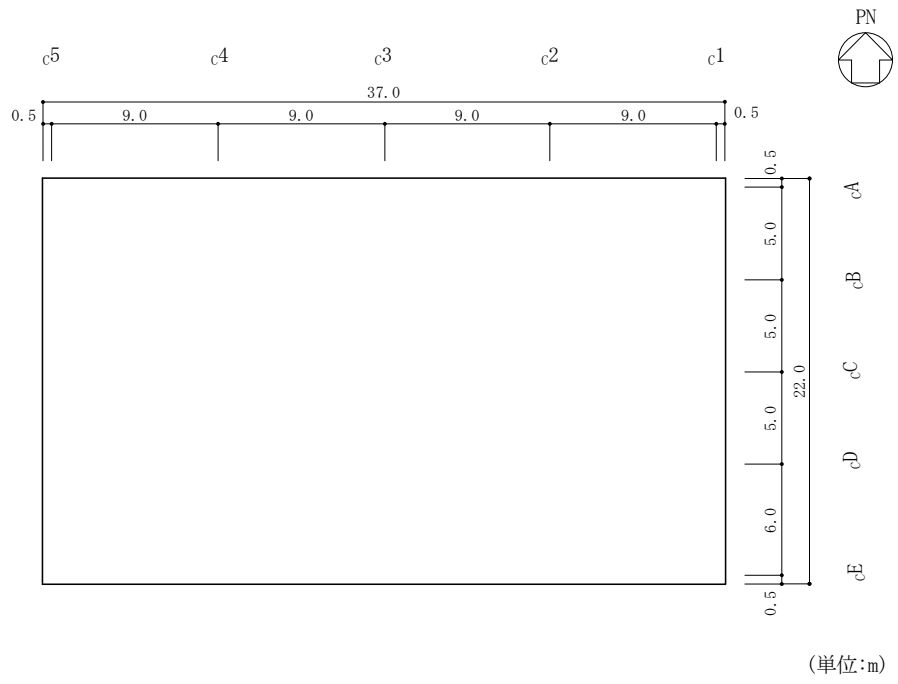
(5) 制御室建物の概略平面図 (EL 22.05m)
